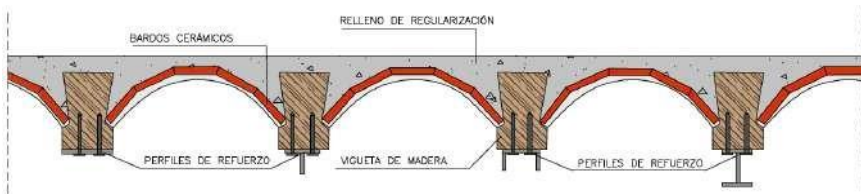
Refuerzo con incorporación de piezas metálicas. Fuente propia
